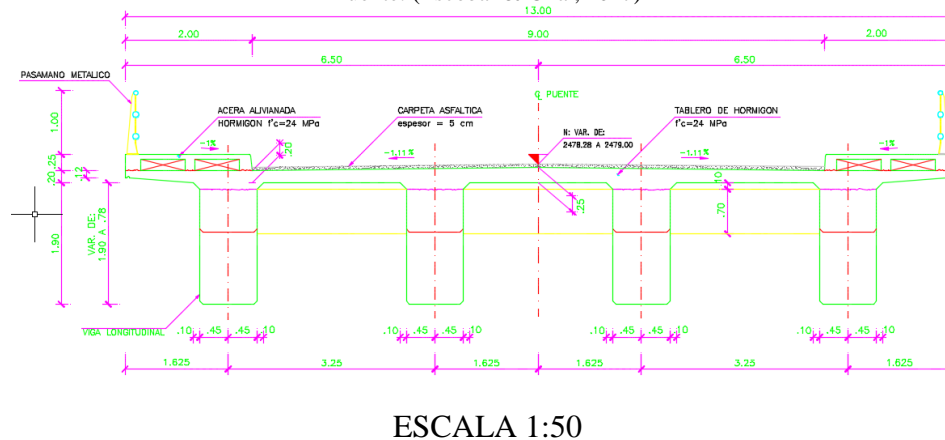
Corte transversal puente de hormigón armado Isla Genovesa.
